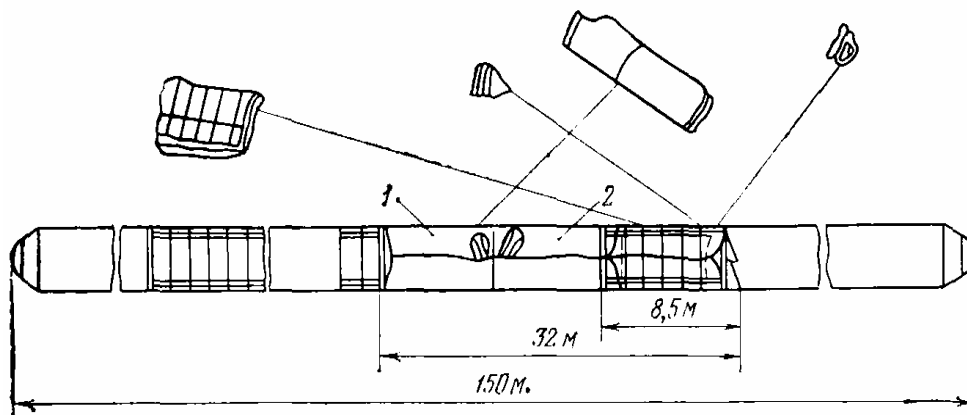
Схема руйнування відрізка газопроводу довжиною 150 м із багатошарових труб розмірами 1420х(4.3х4) мм із сталі 09Г2СФ
